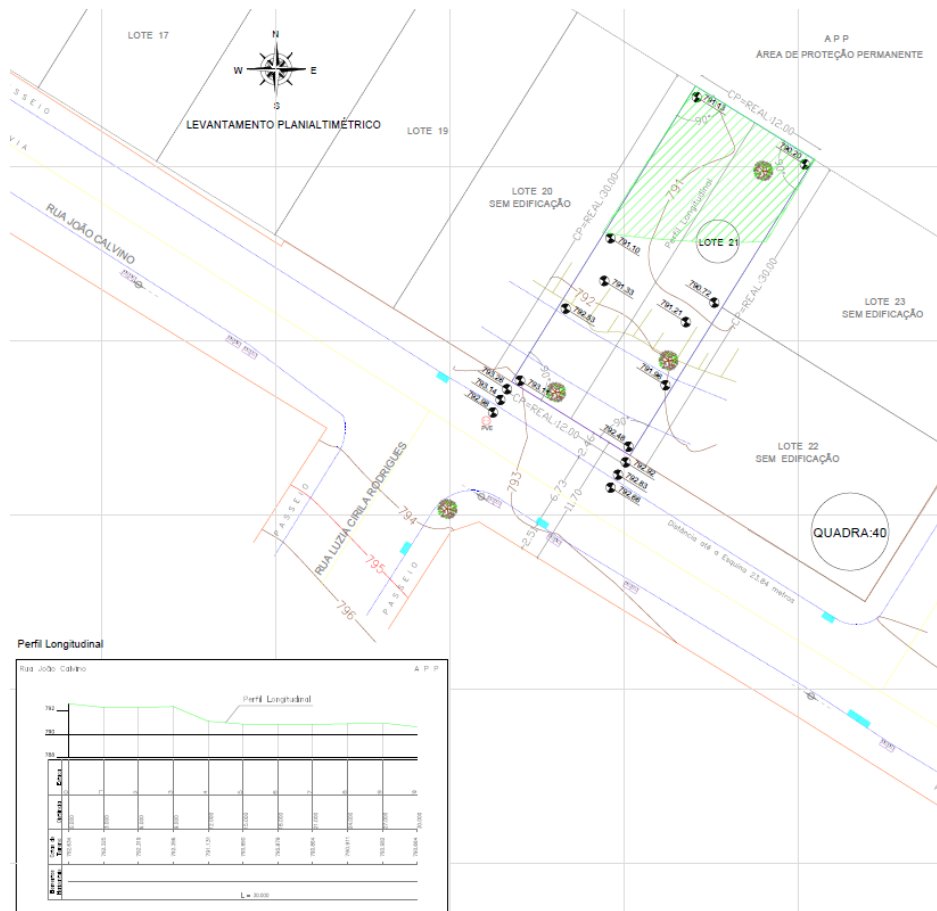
Levantamento Planialtimétrico. Fonte: Requerente, 2025.
